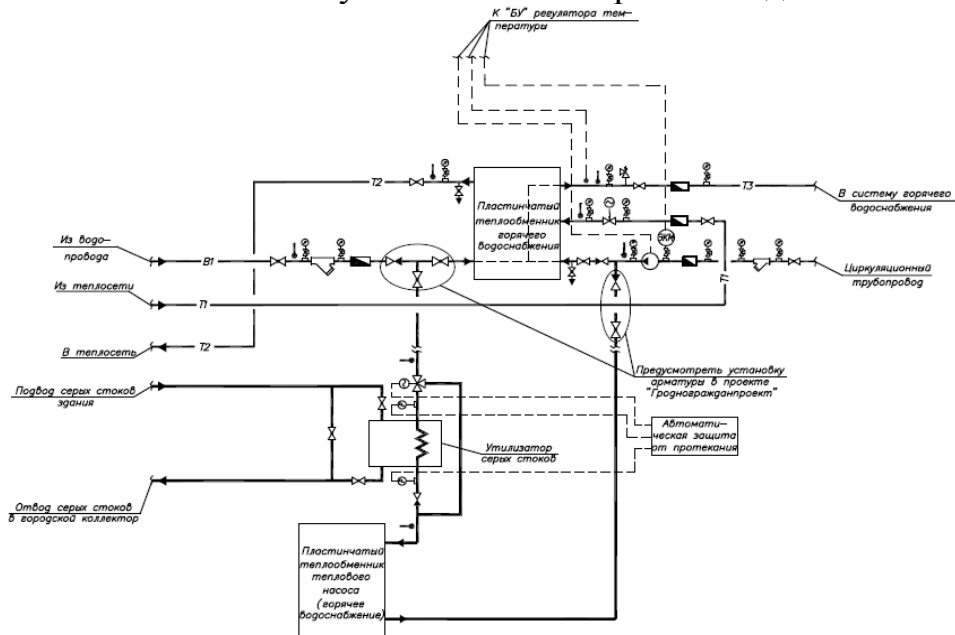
Проектное решение схемы врезки теплоснабжения от теплового насоса в тепловой узел к системе горячего водоснабжения жилого дома
